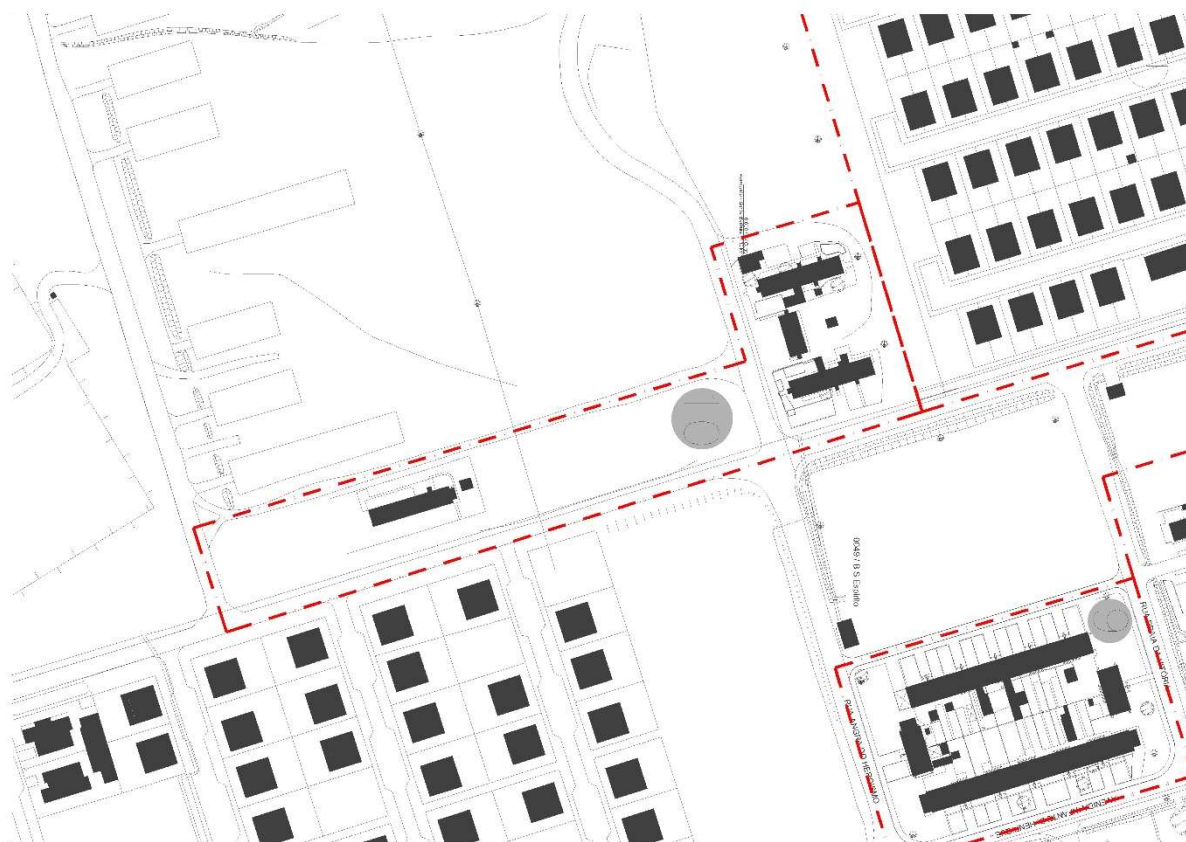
Planta do Bairro da PSP (Extrato de Planta Cedida Pelas Ilhas de Valor)
